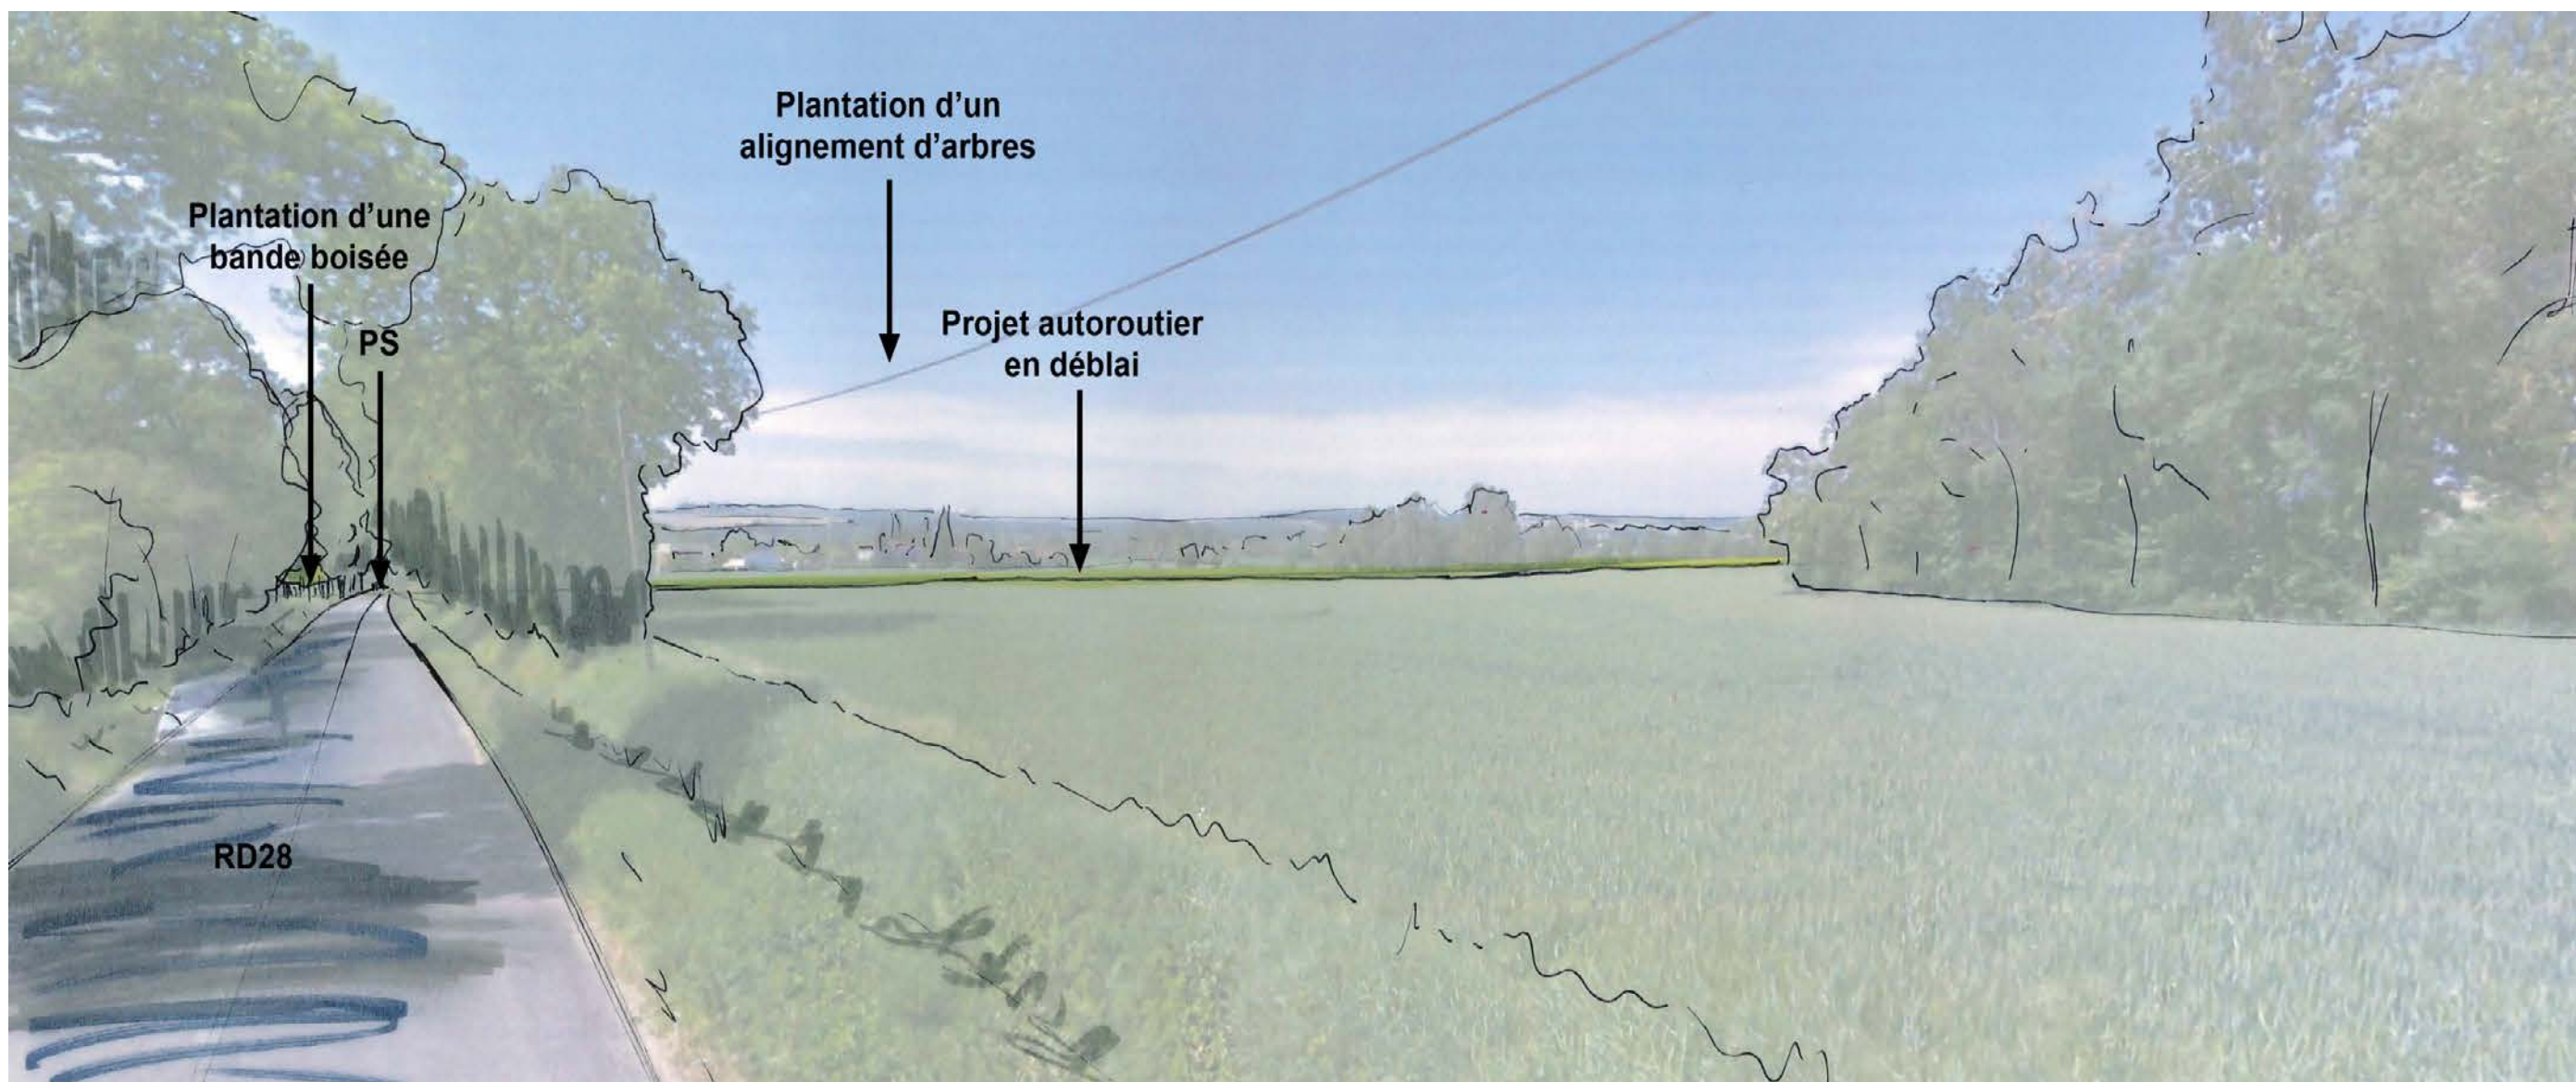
Croquis 2 sur le secteur de Teulat (vue 2 sur le plan masse)
